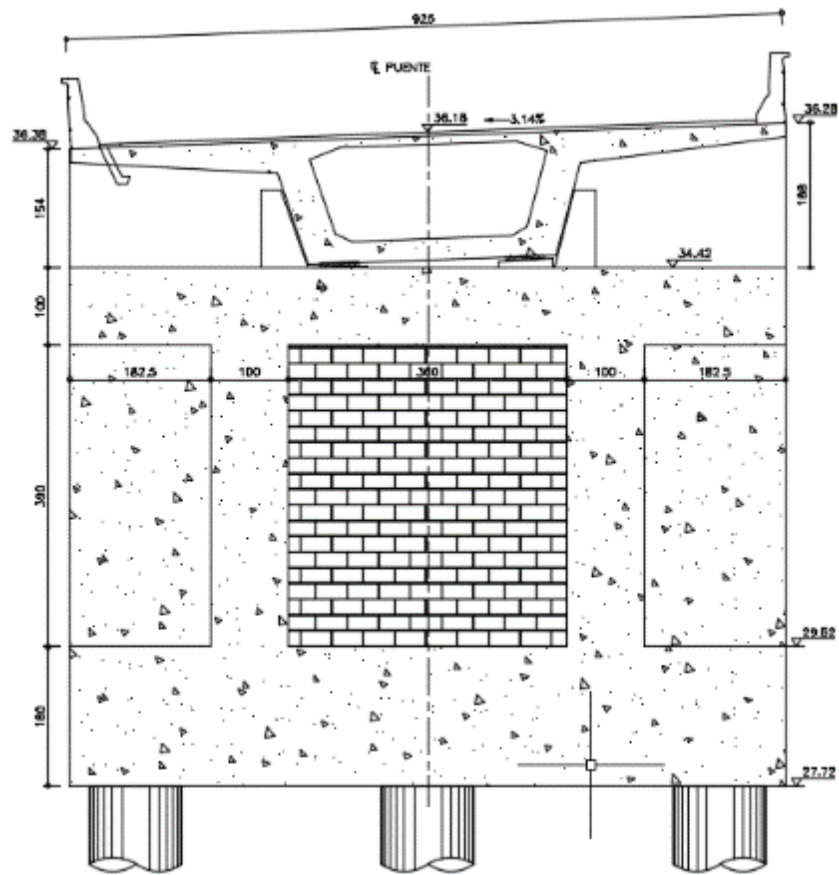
Geometría apoyo eje 5 – Puente Vía a Minca
